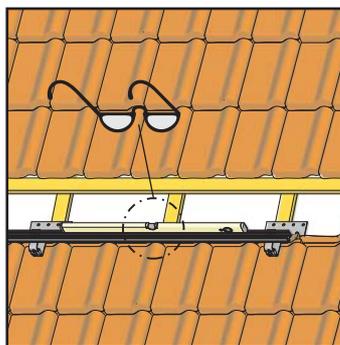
Alignez les profilés parallèlement au bord des tuiles
